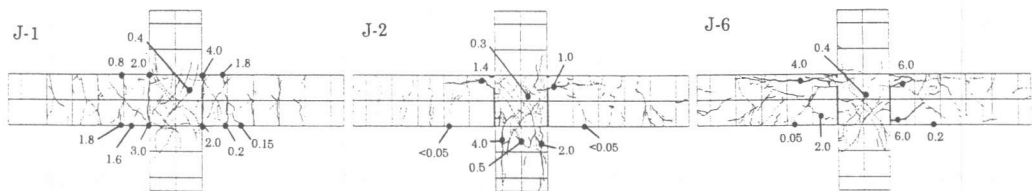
最終ひび割れ性状（数字は水平変位を 0 に戻した後の残留ひび割れ幅）
